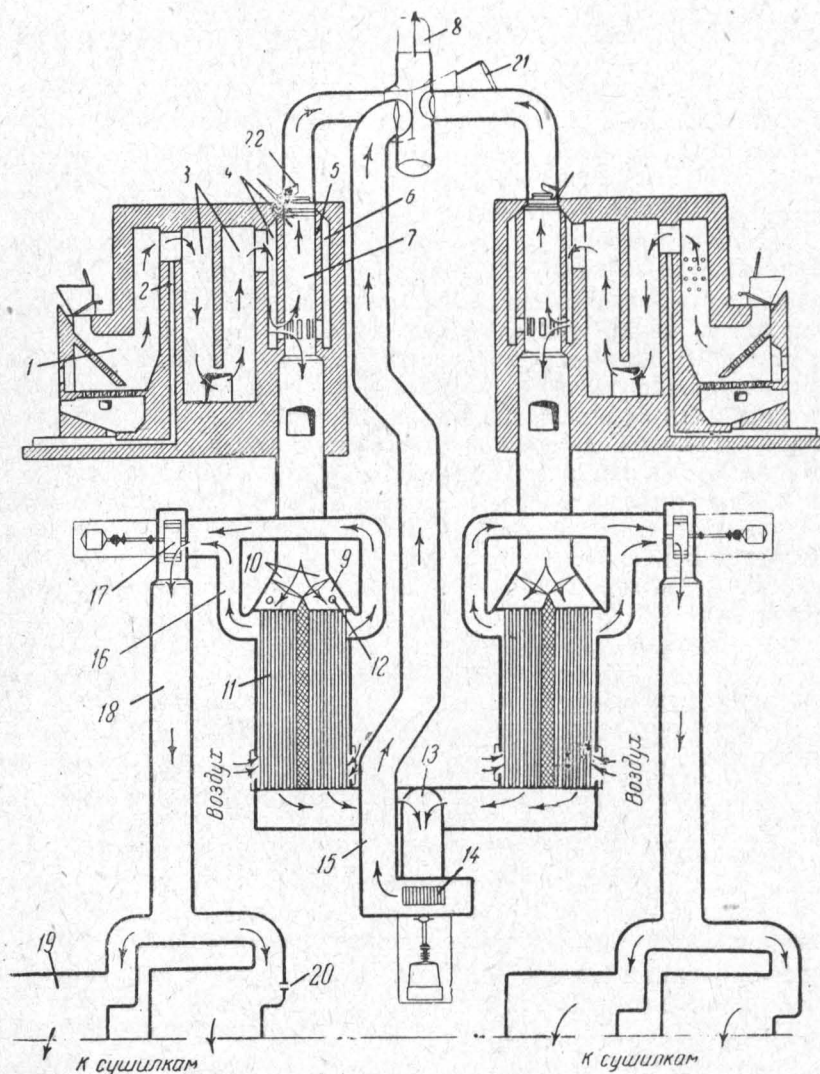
Схема топочного устройства и газораспределения воздушной сушилки с дымогазовыми калориферами
